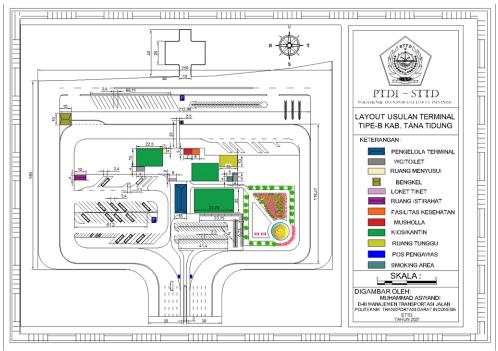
Layout Usulan 1 Fasilitas Terminal tahun dasar (2024)
